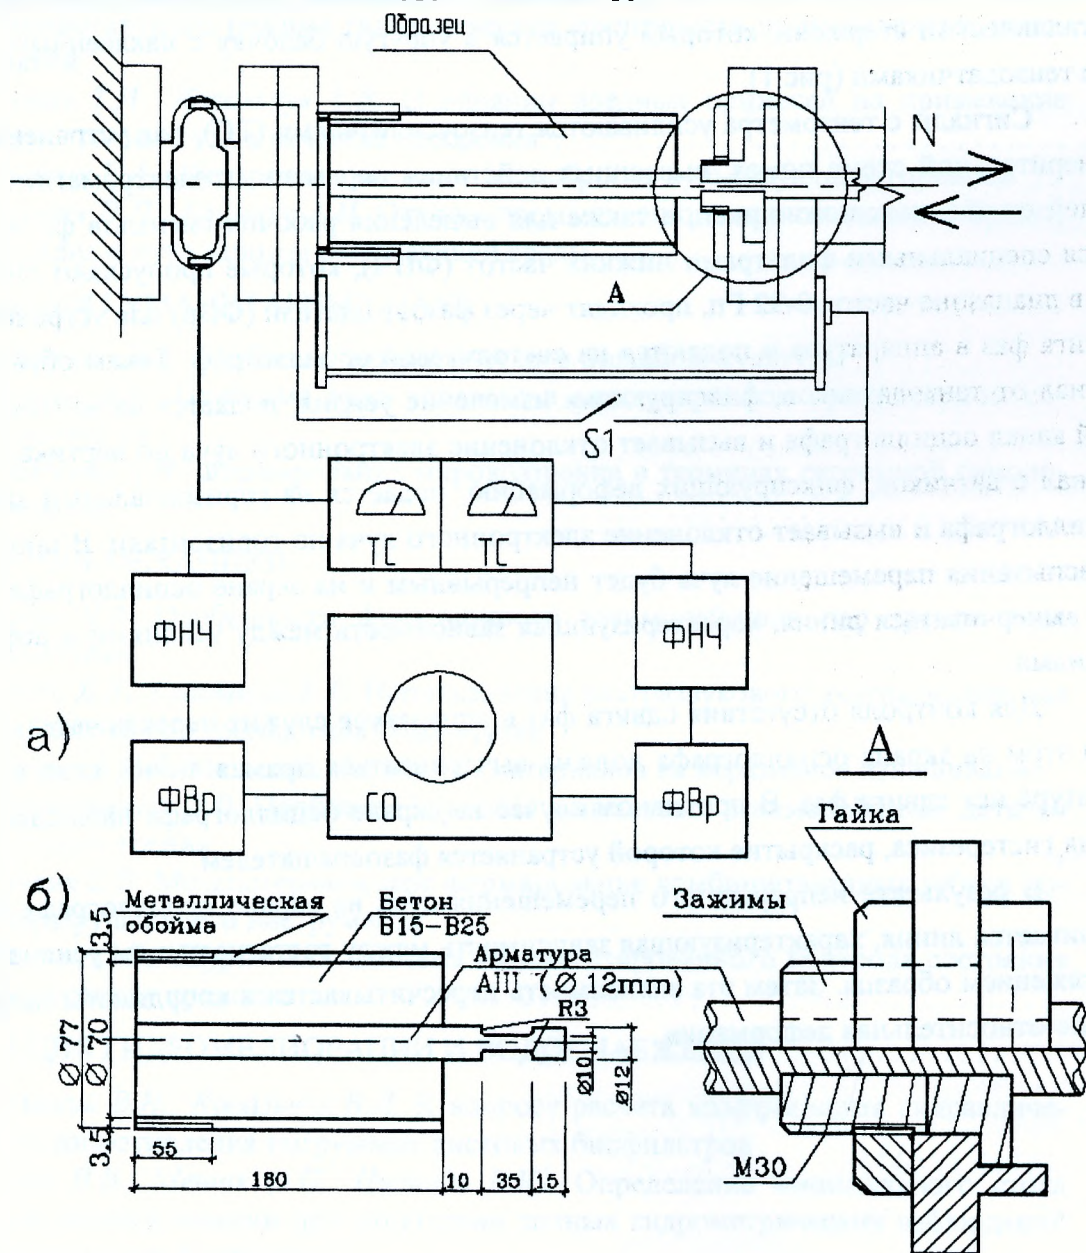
Схема испытательной установки для исследования сцепления арматуры с бетоном (а) и чертеж образца для испытаний (б).
